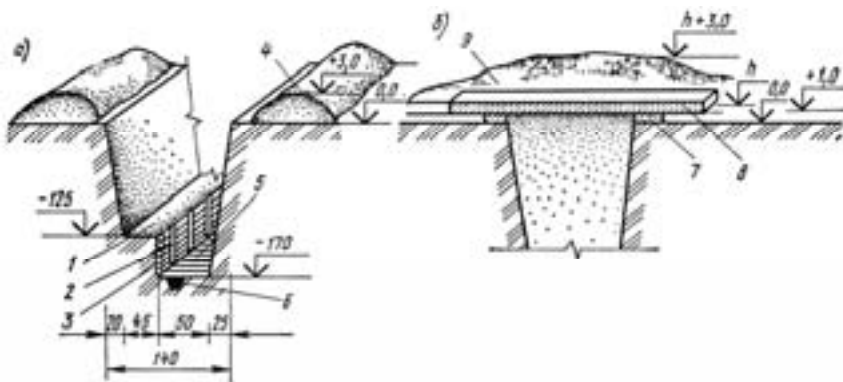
Щілина: а) відкрита; б) з перекриттям із залізобетонних плит;
